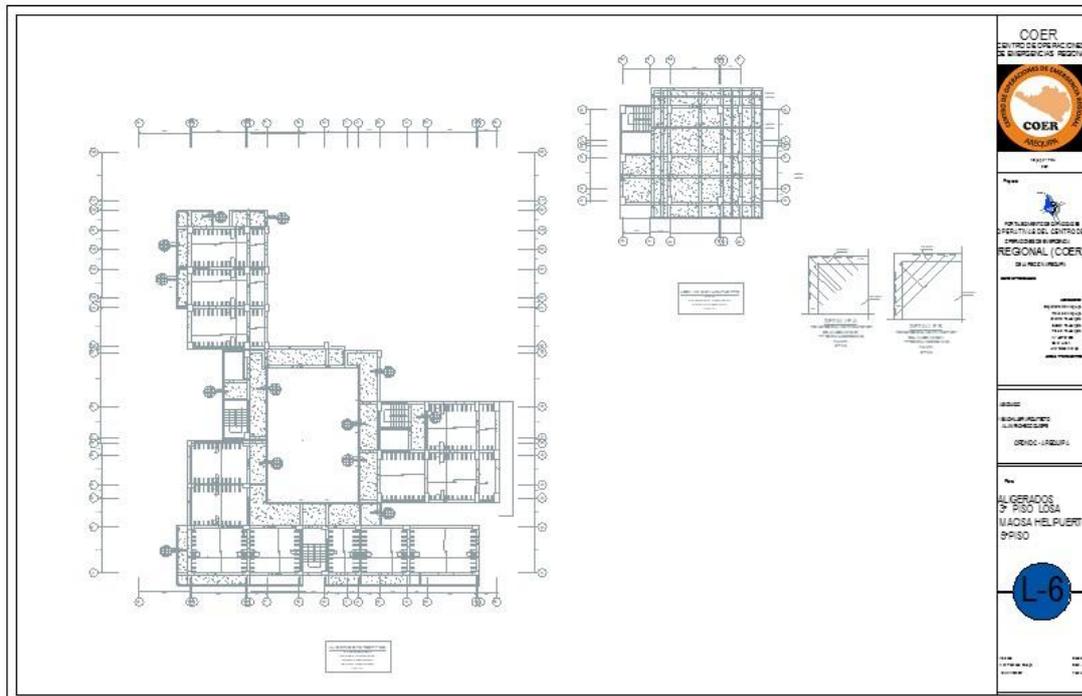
Aligerados 3º Planta Piso Losa Maciza Helipuerto 5º Planta
